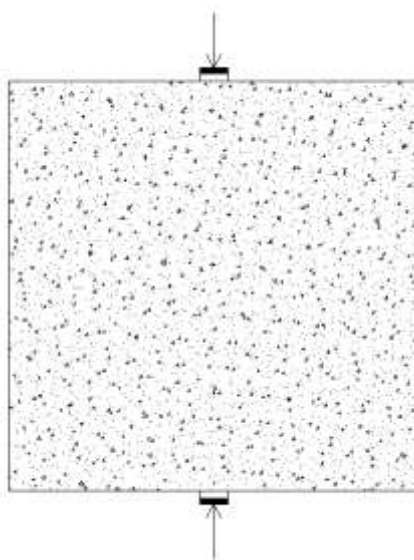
Esquema de ensaio de tracção por compressão diametral
